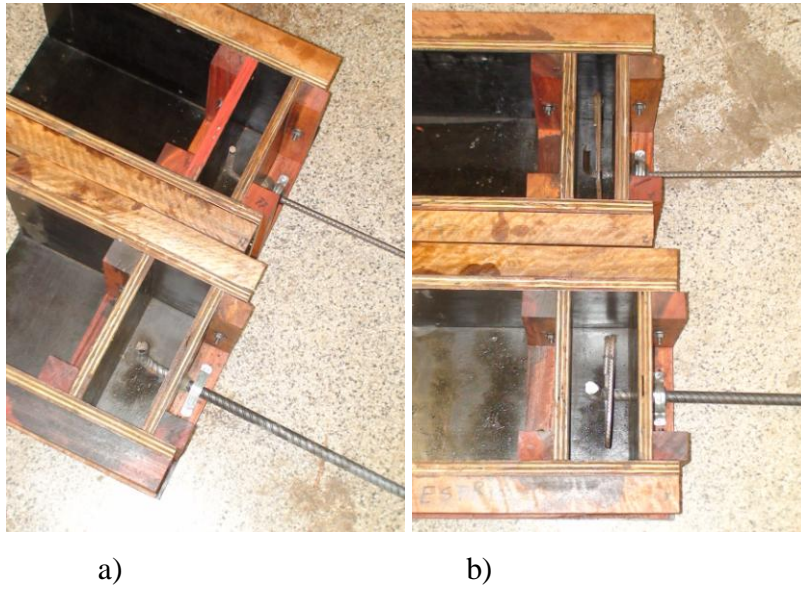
Modelos para barras de 10 e 16 mm com gancho sem estribos (a) e com estribos (b)
